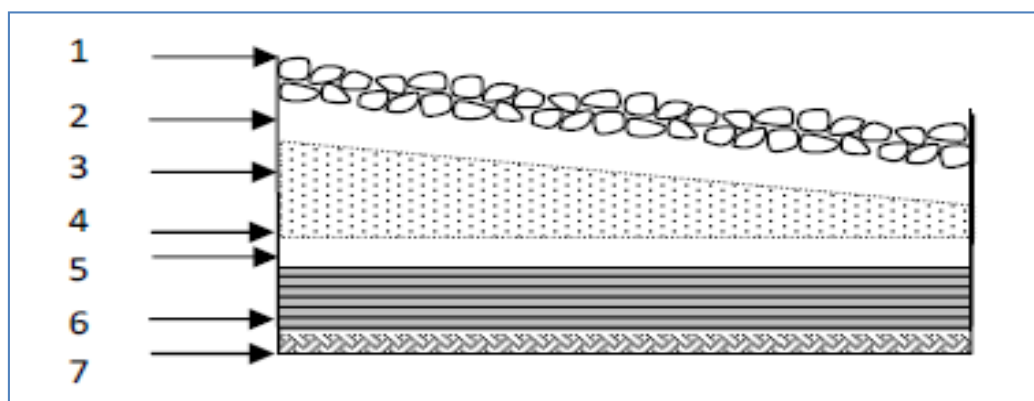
Coupe verticale du dernier plancher (terrasse inaccessible).
